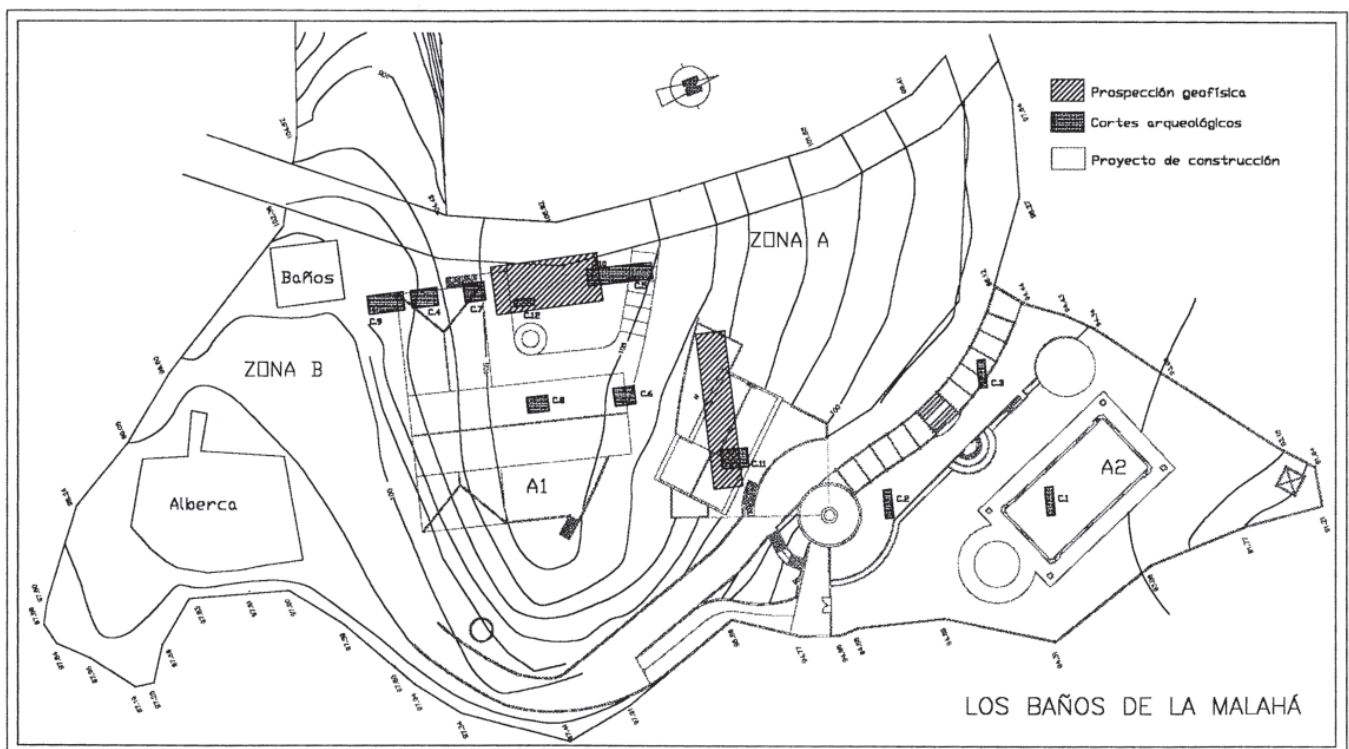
Planimetría general de Los Baños de La Malahá (Zonas A y B).
